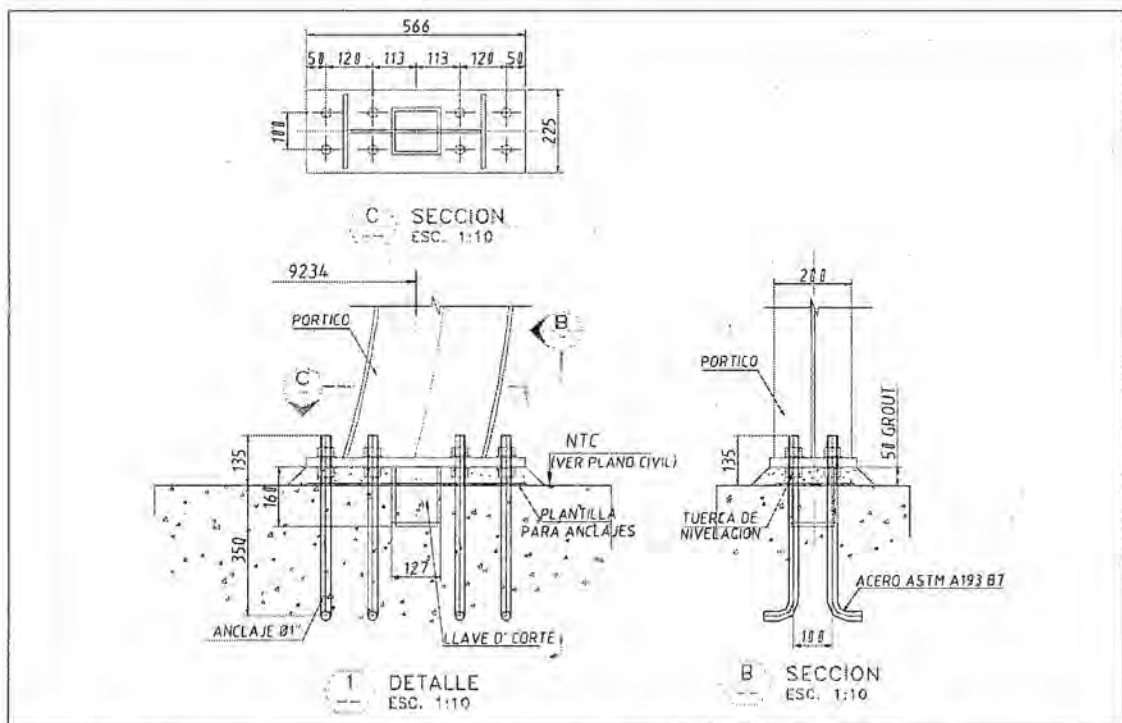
Detalle de Pernos de Anclajes Pórticos Elípticos (Fuente: Tramo 2)
